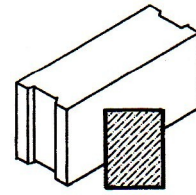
Стрічковий фундамент з монолітного залізобетону:
